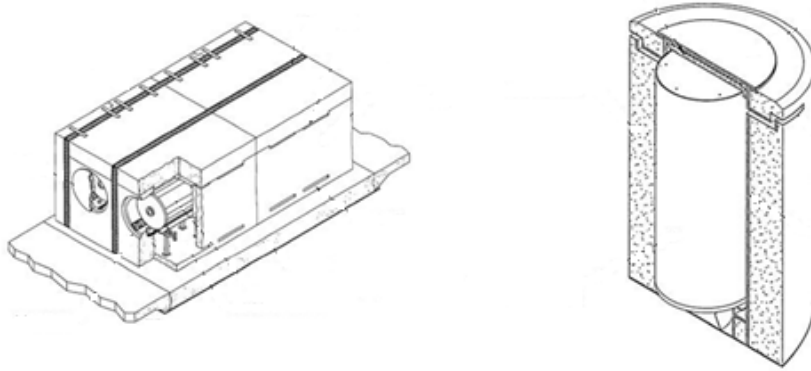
Lagermodul aus Beton mit verschraubtem und geschweißtem Deckel
